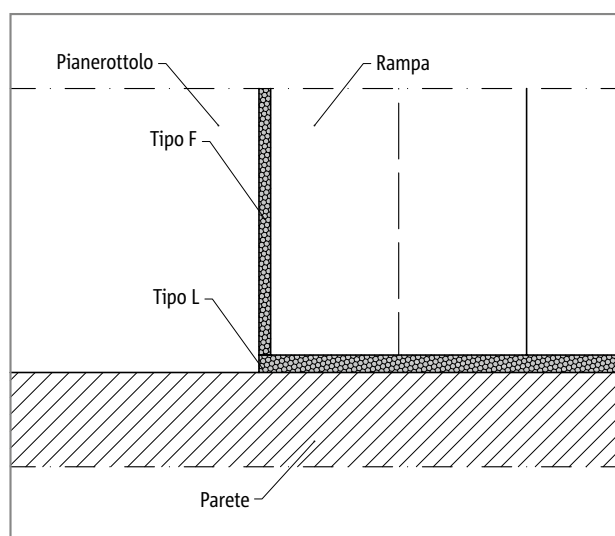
Schöck Tronsole® tipo F, Disposizione dell'elemento; dettaglio B
